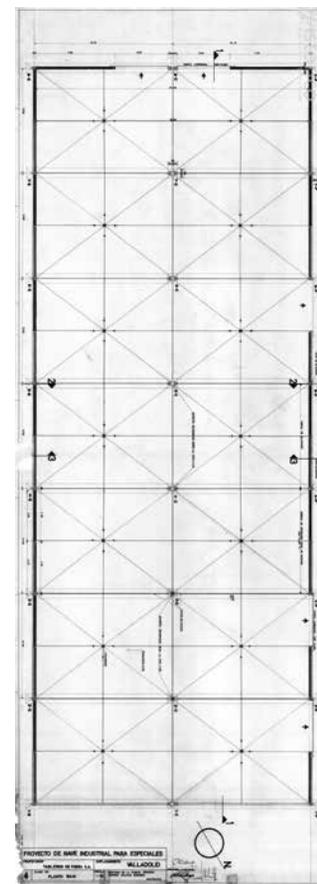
Nave de Tableros Especiales. Plano de Planta Baja.
